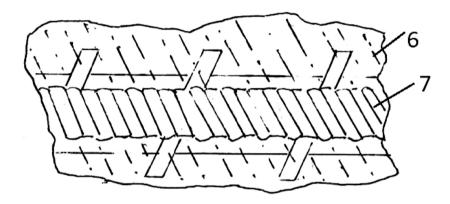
6 – бетон; 7 – арматура Fig. 9. 6 – concrete; 7 – reinforcement
